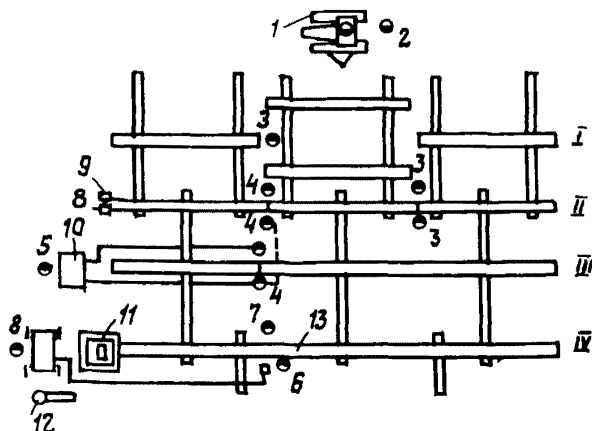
Схема размещения оборудования и рабочих постов на полевой трубосварочной базе для поворотной сварки стыков: I-стеллаж подготовки труб; II, III - сборочный стеллаж; IV-сварочный стеллаж; 1-кран-трубоукладчик; 2-такелажник; 3-слесарь-монтажник; 4-сварщик; 5-слесарь-моторист; 6-сварщик автоматчик; 7-подручный сварщика; 8-моторист; 9-электролебедка; 10-электросварочный агрегат; 11-вращатель; 12-машинка для намотки кассет; 13-электросварочная головка
